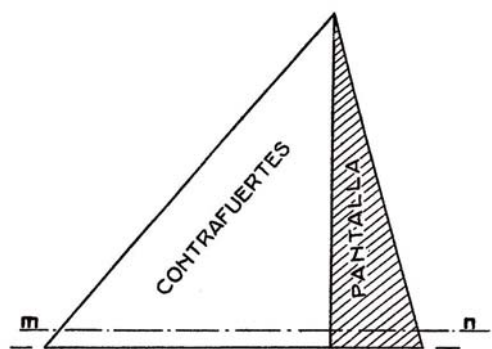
ª Corte-alzado por cc de la figura 2.ª
